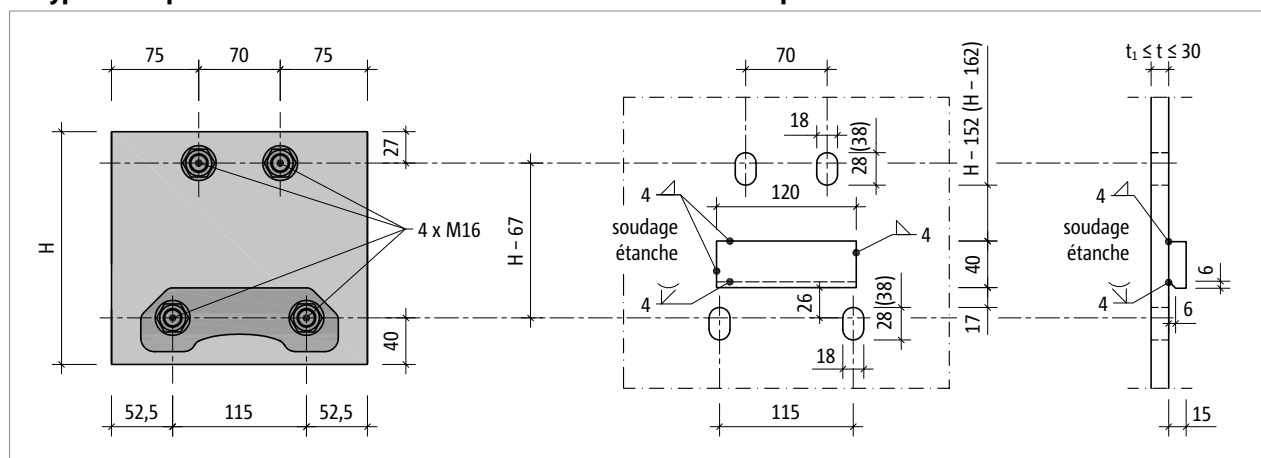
Schöck Isokorb® XT type SK-M1 : construction de la platine frontale de raccordement
